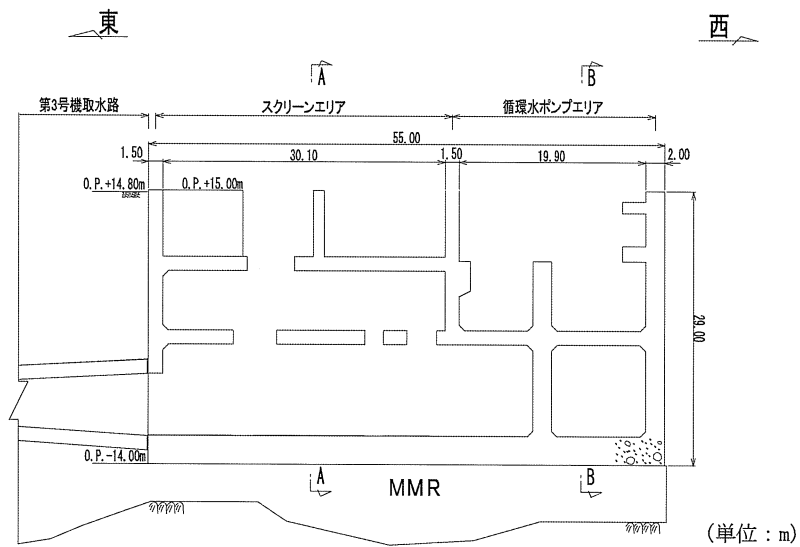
第 3 号機海水ポンプ室断面図 (C-C 断面)
